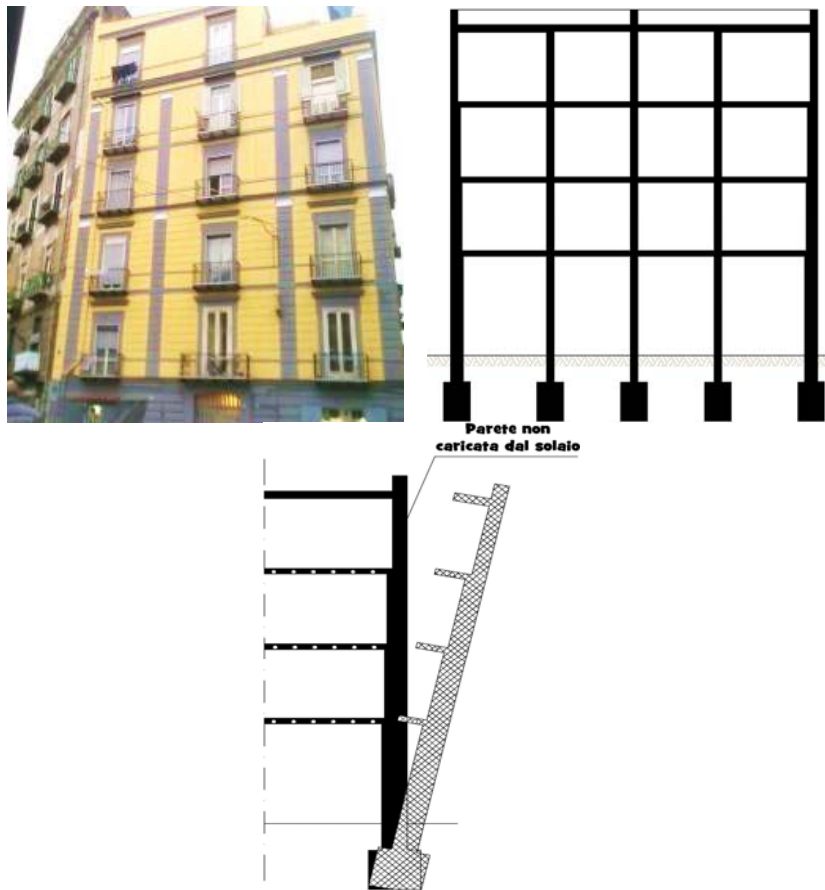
Prospetto, sezione e patologia di un edificio della II classe
